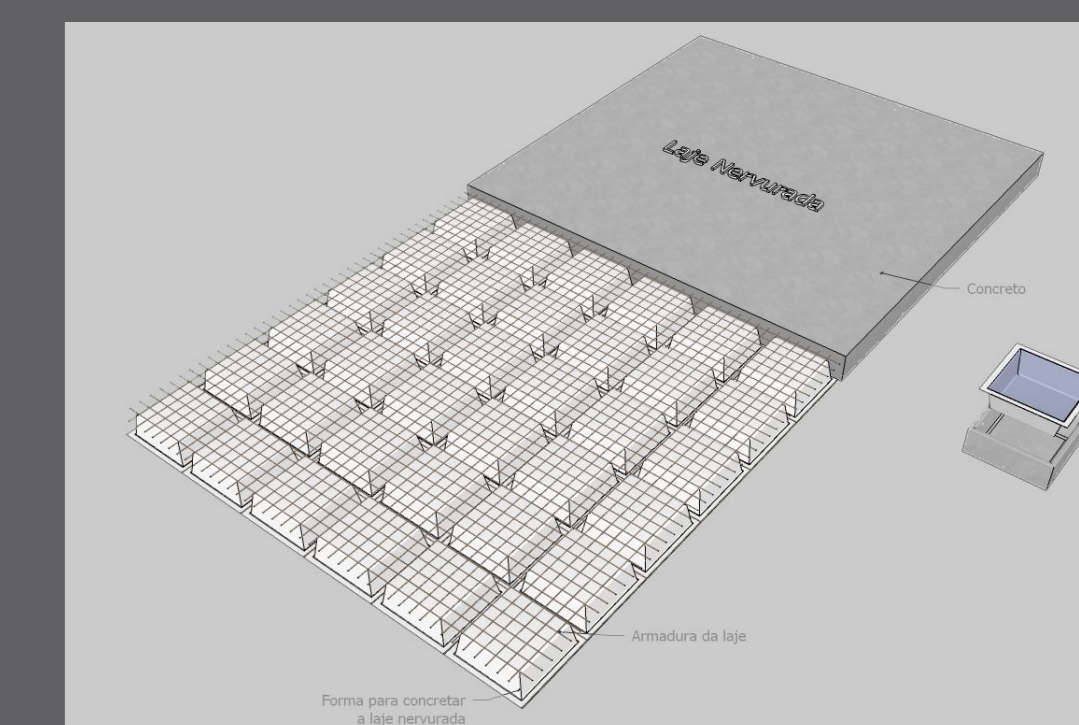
Esquema laje nervurada. Fonte: Catálogo digital de detalhamento da construção, 2012.
